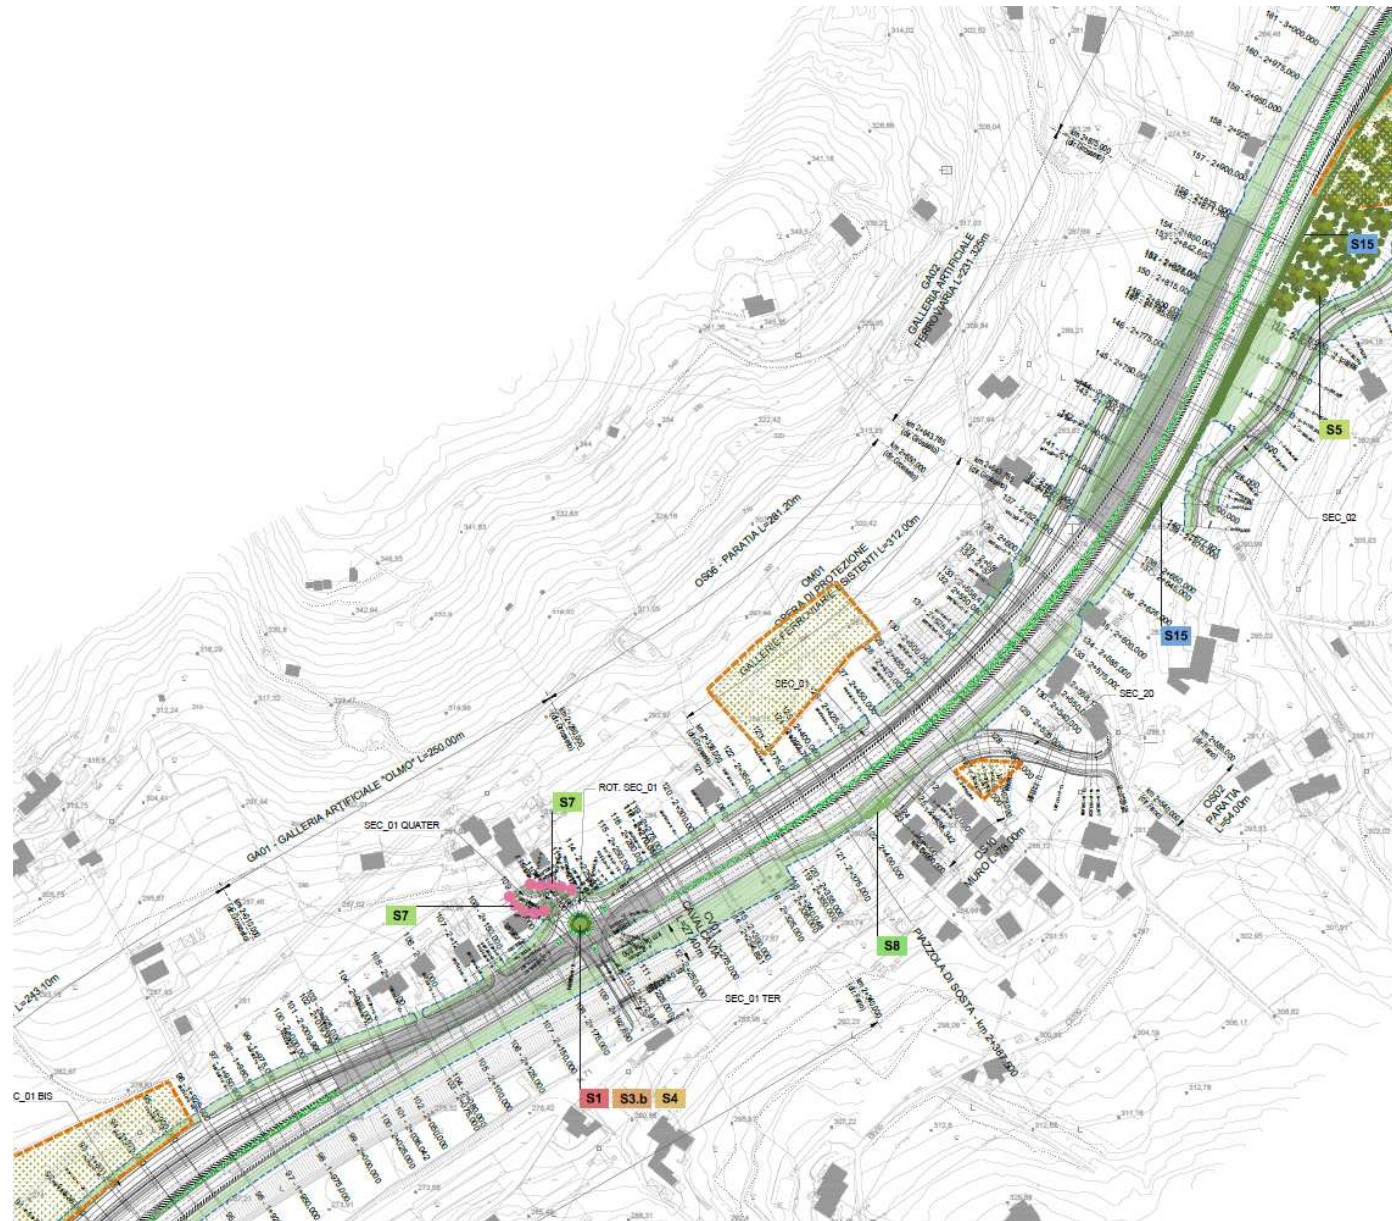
Estratti planimetrie opere a verde - T00AM06AMBPL04
